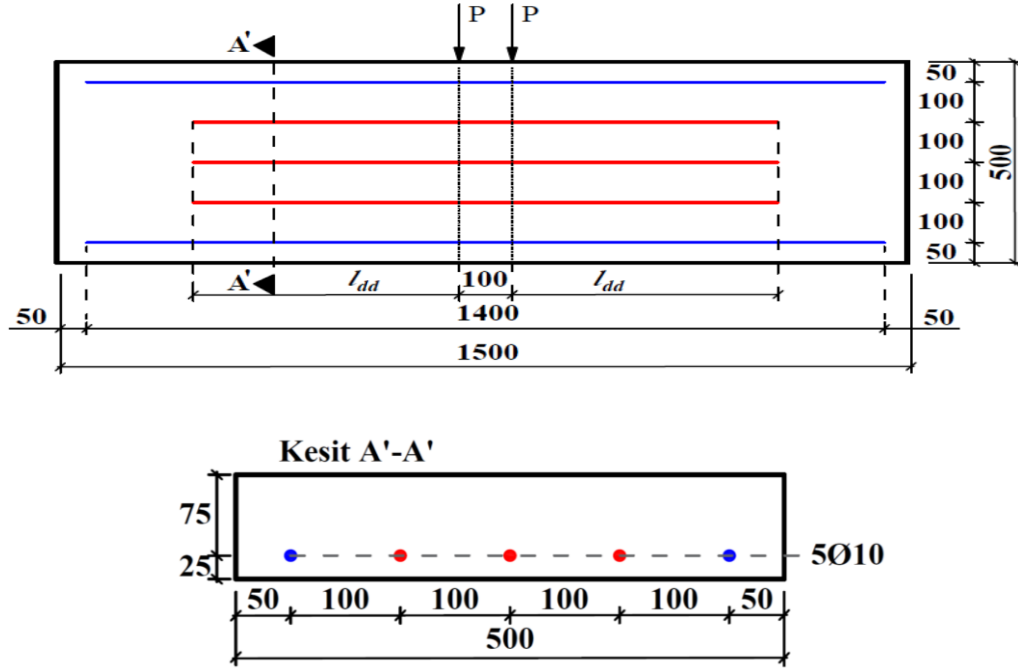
3. RCS betonarme döşemelerine ait kesit özellikleri ve donatı düzeni.
